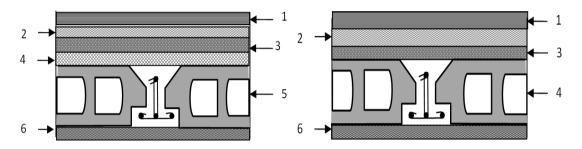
Coupe transversale d'un plancher terrasse inaccessible et étage courant
